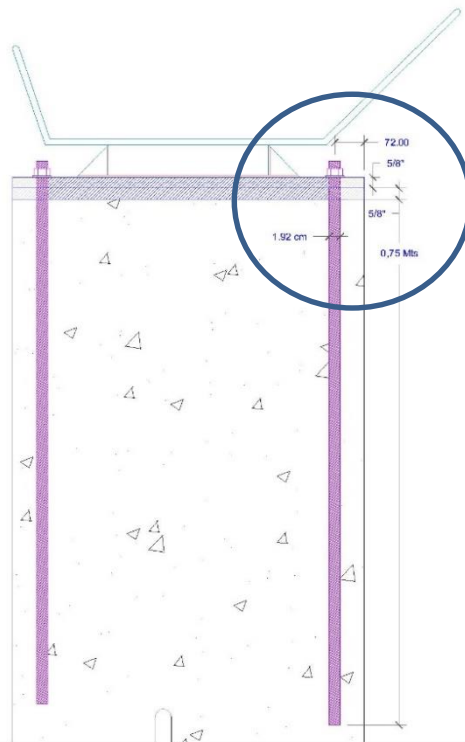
Corte de la sección del anclaje, placas base y canaleja para la estructura de arco techo.
